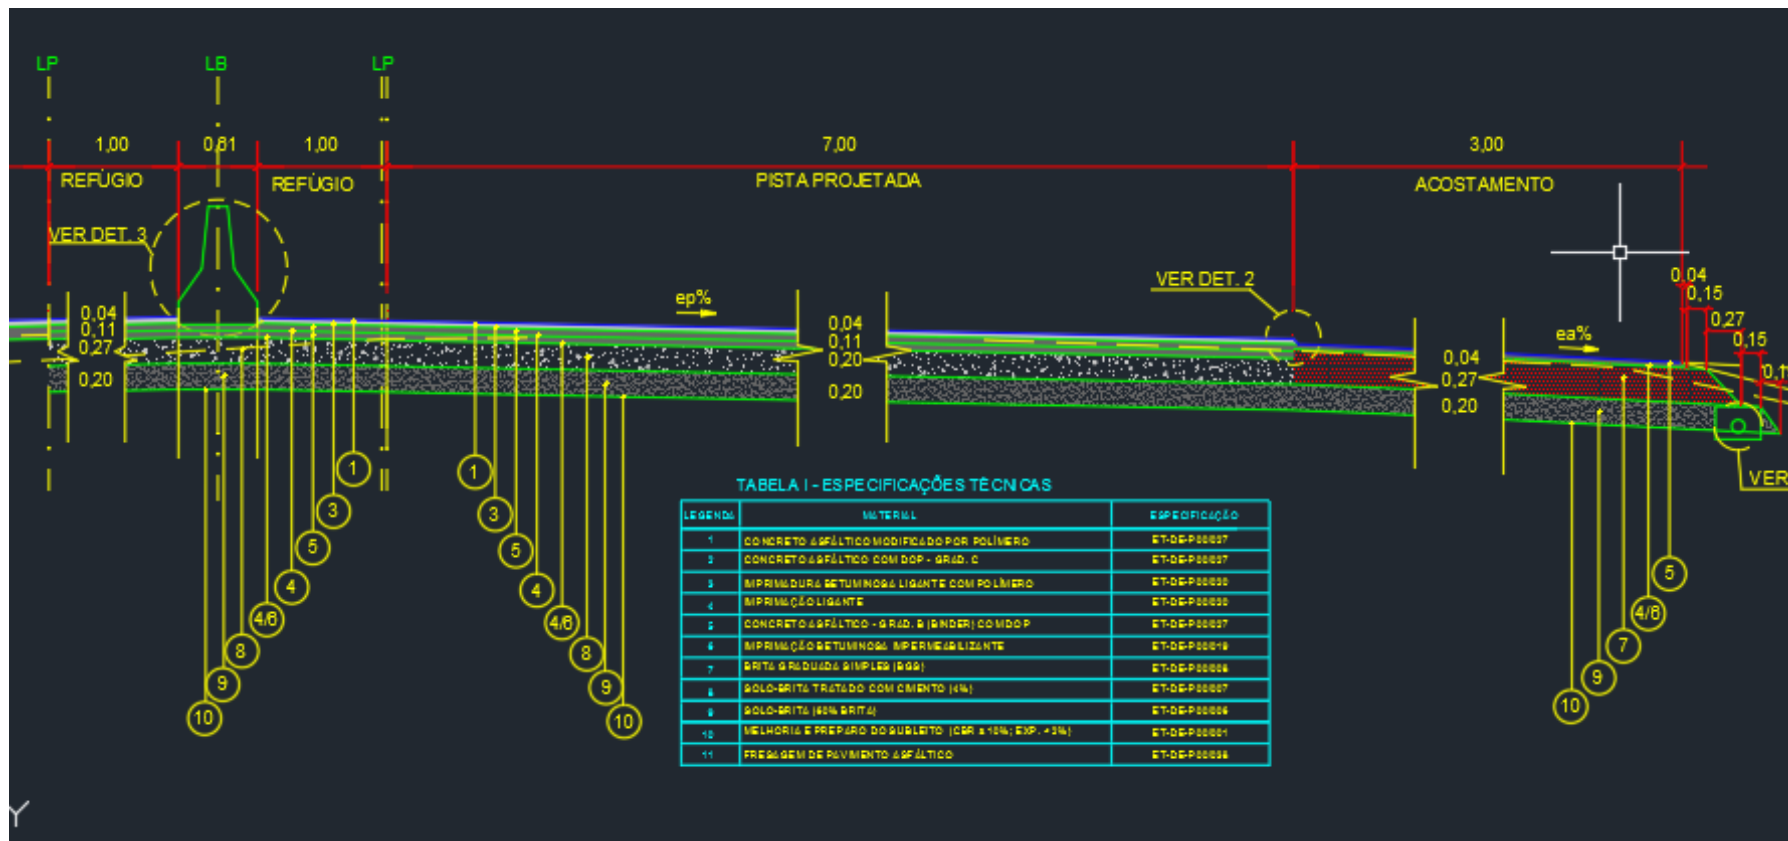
Corte transversal tipo – Estrutura pavimento semi-rígido.
